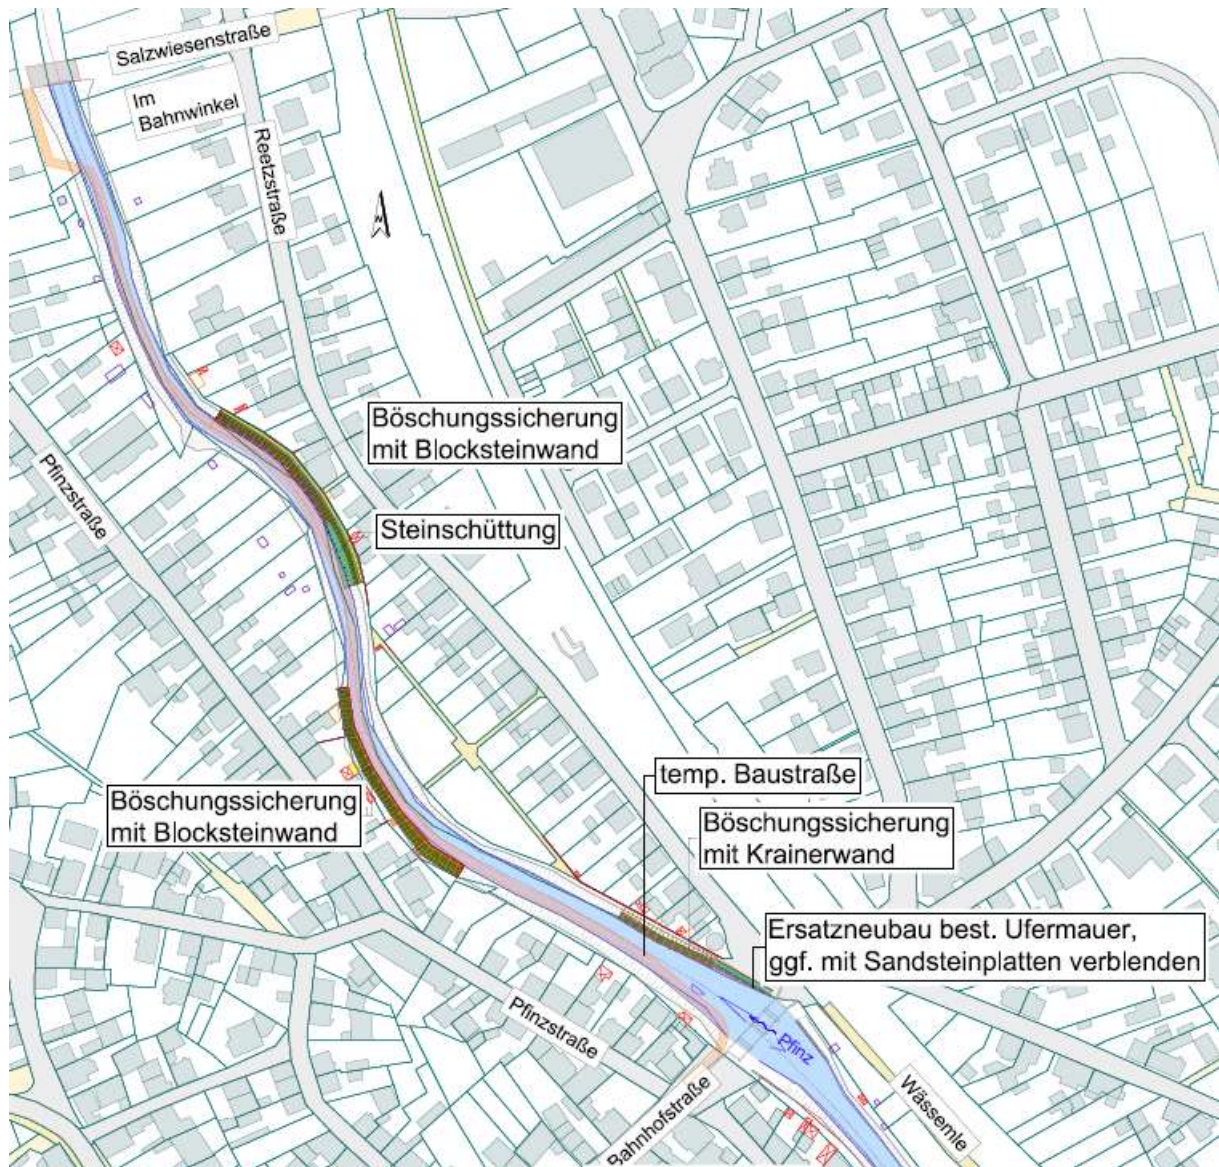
Bauabschnitt 1, Bereich unterstrom der Bahnhofstraße, Lageplan
